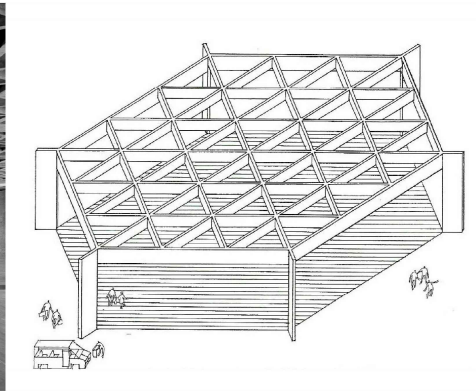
"Secção - activa" | Sistema de malhas de vigas (Engel, 1967: p.204)
